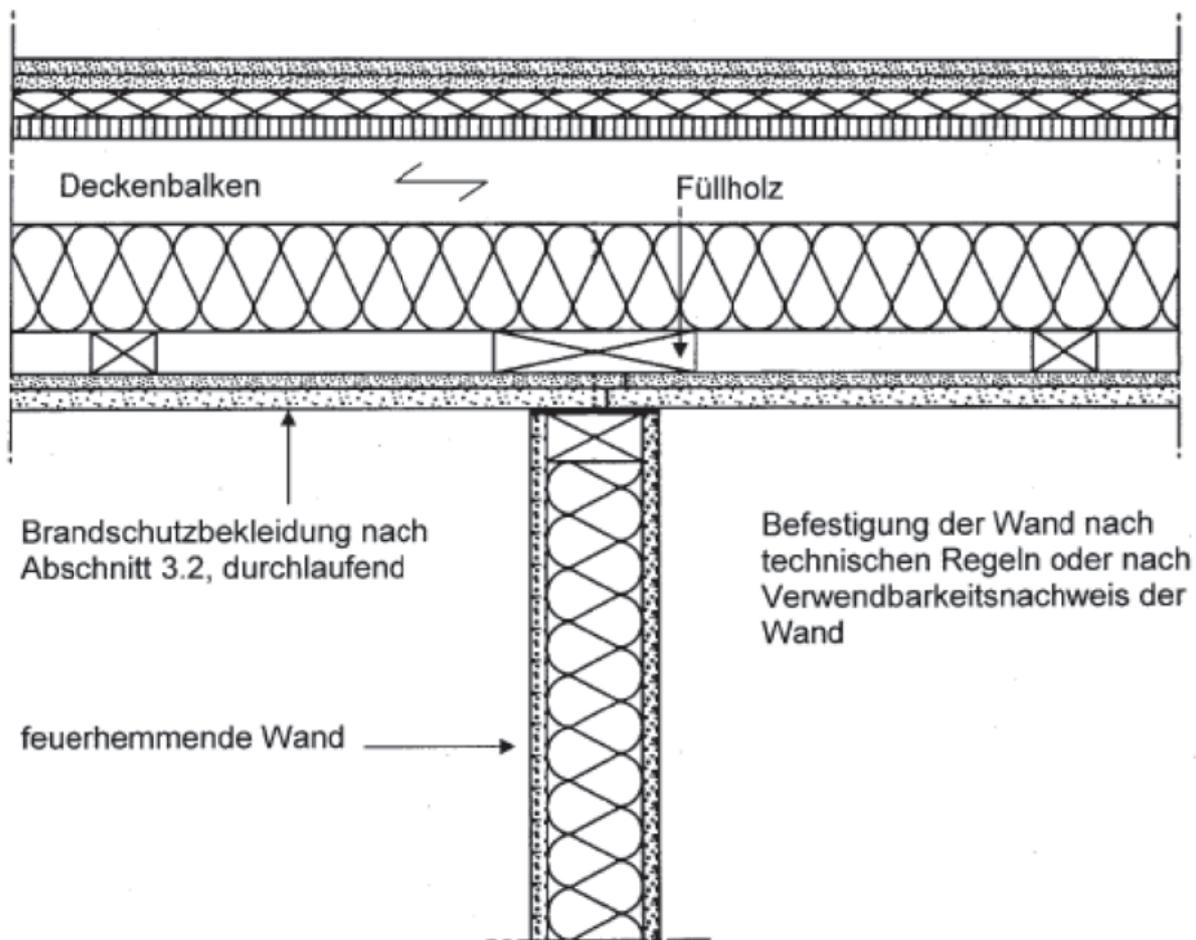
Anschluss einer feuerhemmenden, raumabschließenden, nichttragenden Wand (z. B. Flurwand mit Anforderung feuerhemmend) an eine Decke nach Abschnitt 3.3.3
